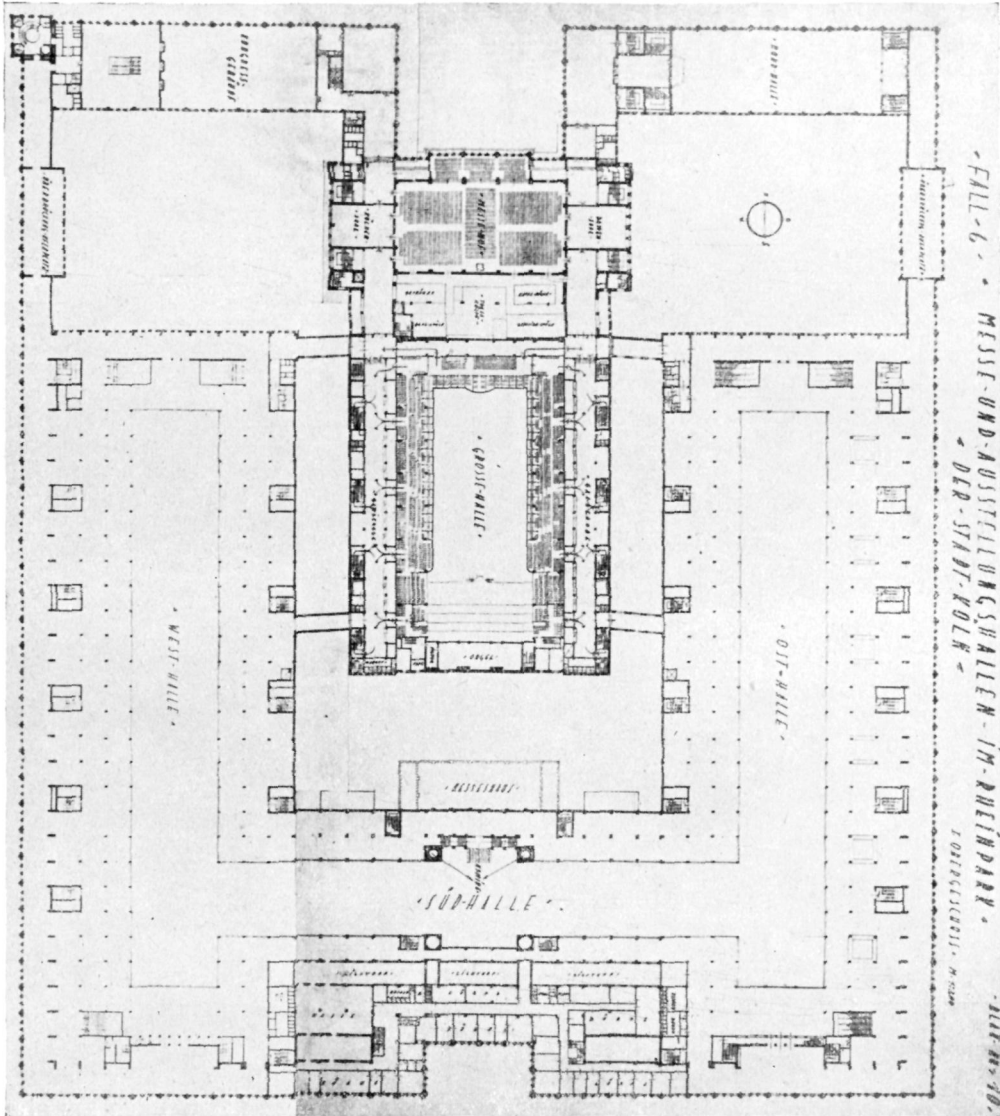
Messe- und Ausstellungshallen Köln. 1. Obergeschoß-Grundriß
